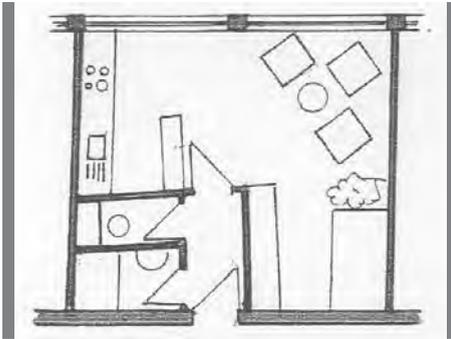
Grundrissdarstellung - Unterkunftsmodul D
